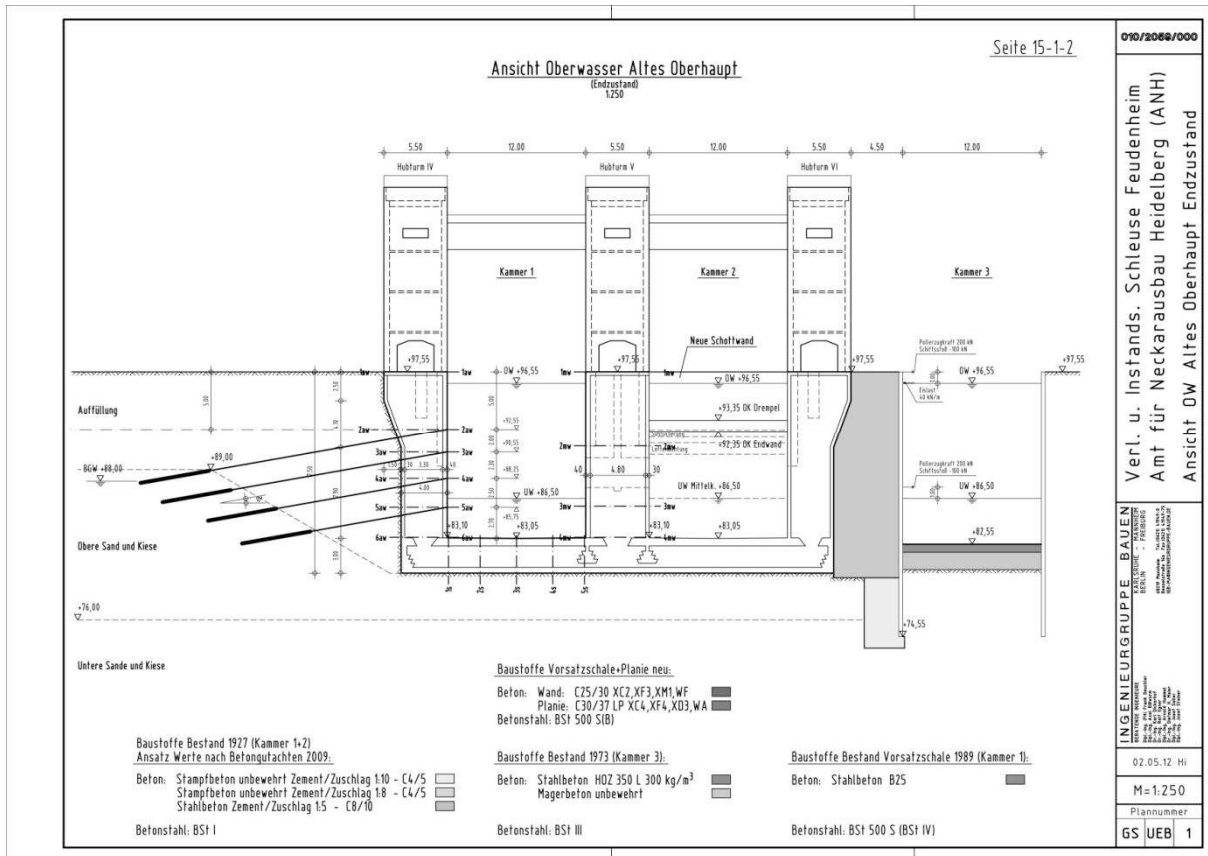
Ansicht bestehendes Oberhaupt mit Ertüchtigungsmaßnahmen aus FEM-Berechnung (Entwurf)
